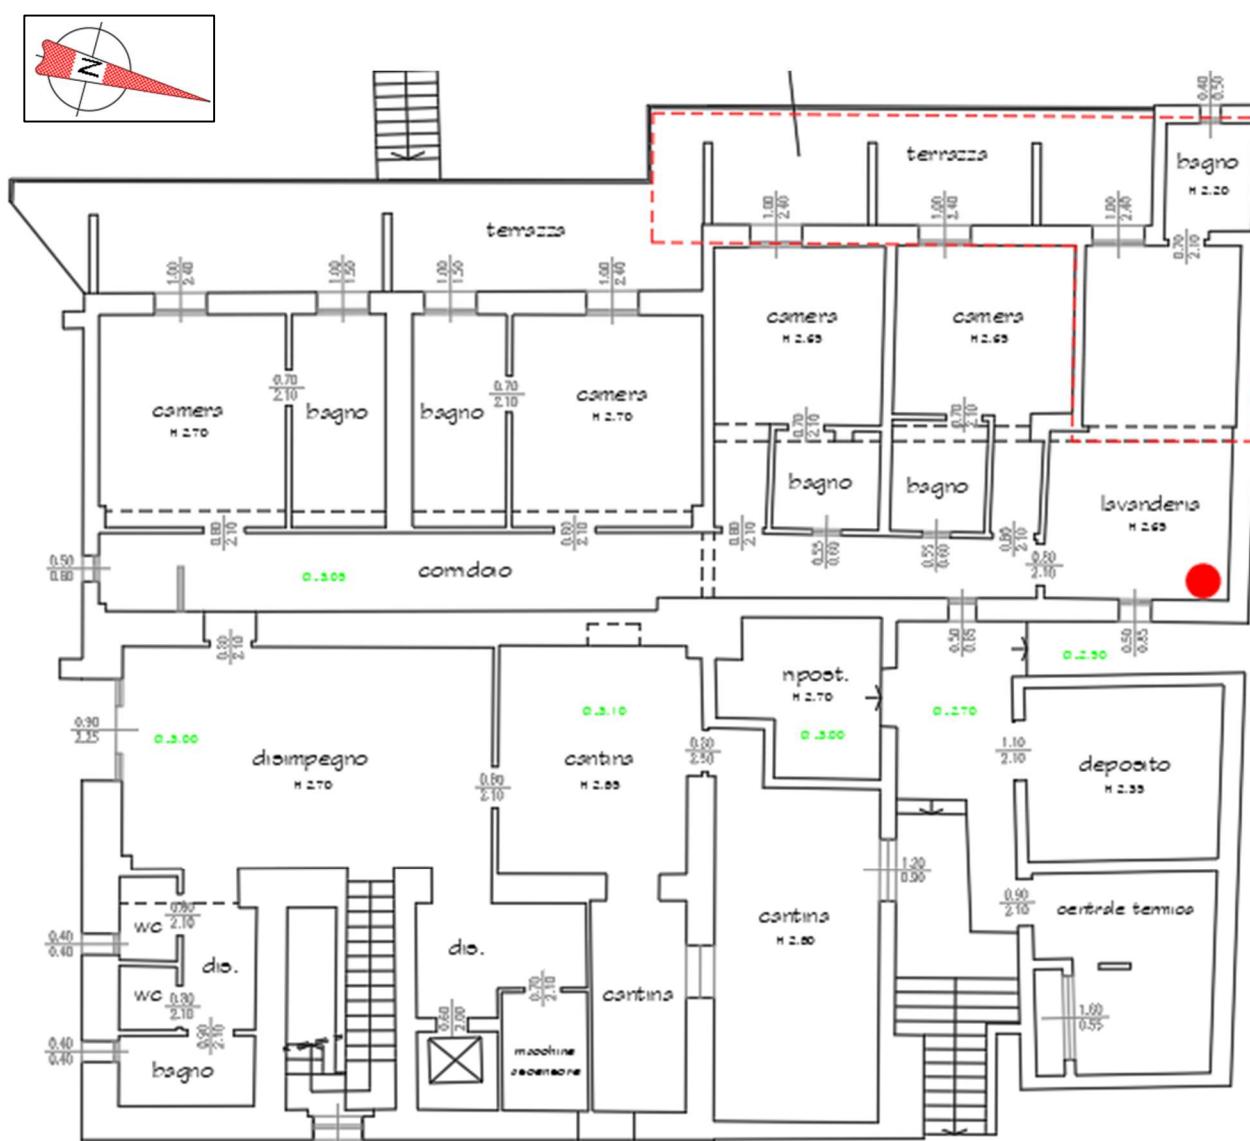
Planimetria del piano semi-interrato. In rosso è indicata l'ubicazione del punto di monitoraggio.
